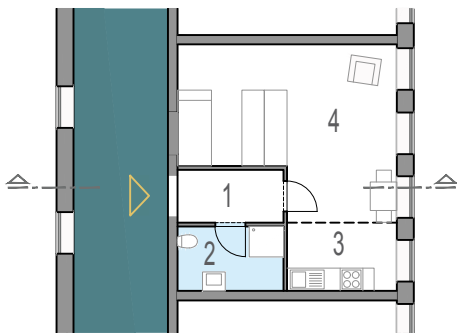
Grundriss Singlewohnen M 1:200
